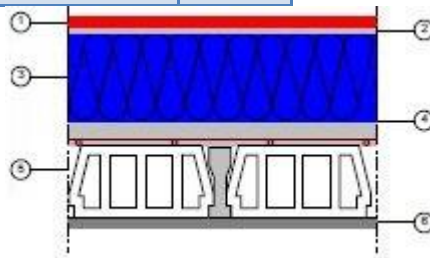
Detalle constructivo de los componentes de la cubierta tipo 2 tras la mejora.
